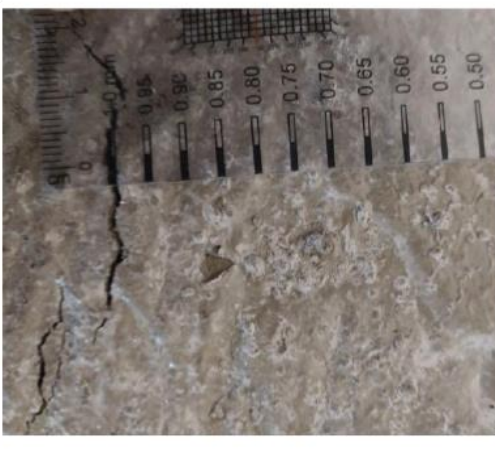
Medición del ancho de fisuras en el panel de concreto de referencia con la tarjeta comparadora de fisuras.
